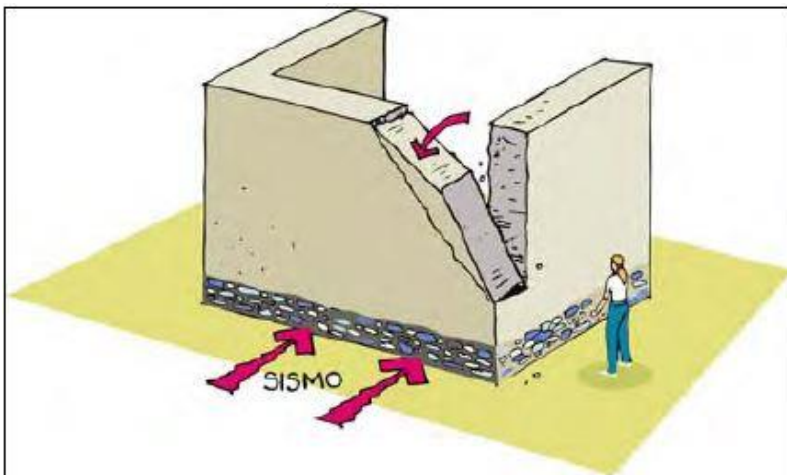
Colapso muro por grietas horizontales y carga sísmica transversal.
